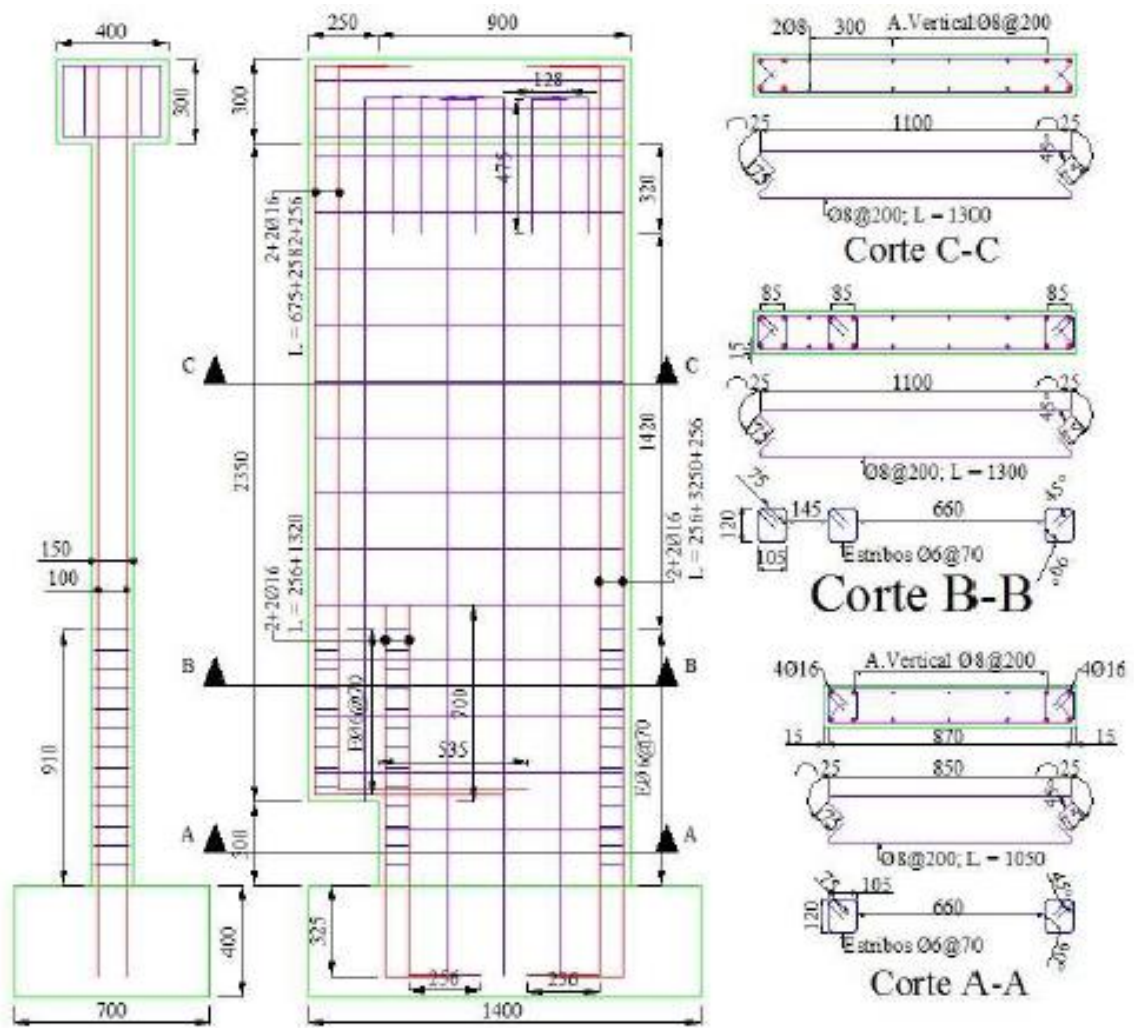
Detallamiento de la armadura de la probeta 1 de muros bandera.
